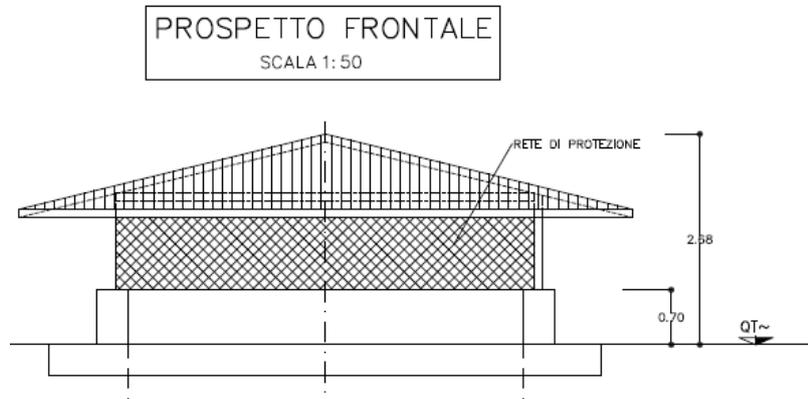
WBS GN170 – prospetto frontale della parte emergente dal terreno
